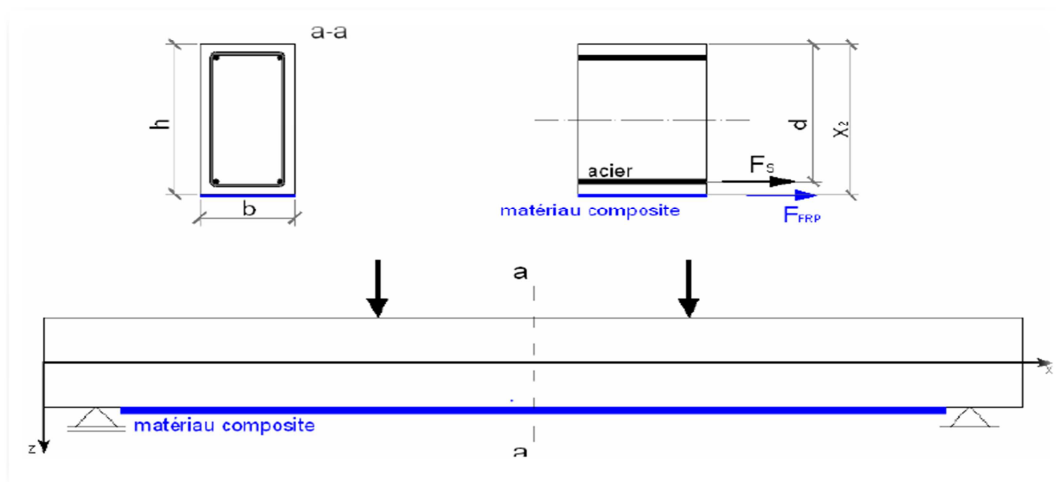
Présentation d'une poutre en béton armé soumise à la flexion. [45]
